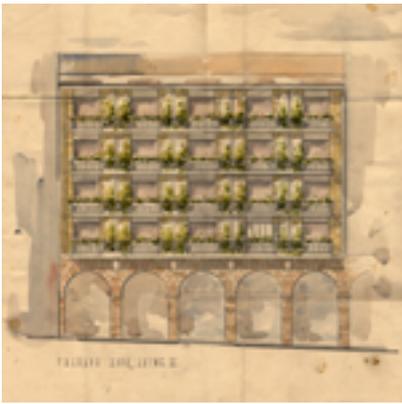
José Ferragut Pou. Alzado del edificio de viviendas en Jaime III, número 24, 1962. Archivo José Ferragut Pou
